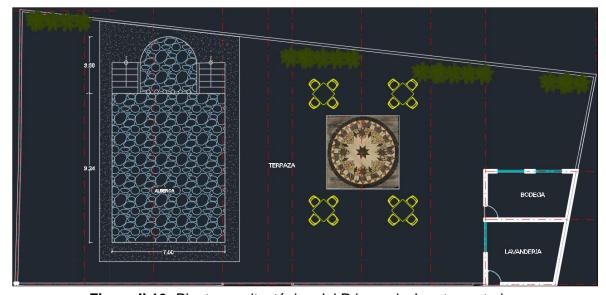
Planta arquitectónica del Primer nivel parte posterior.
